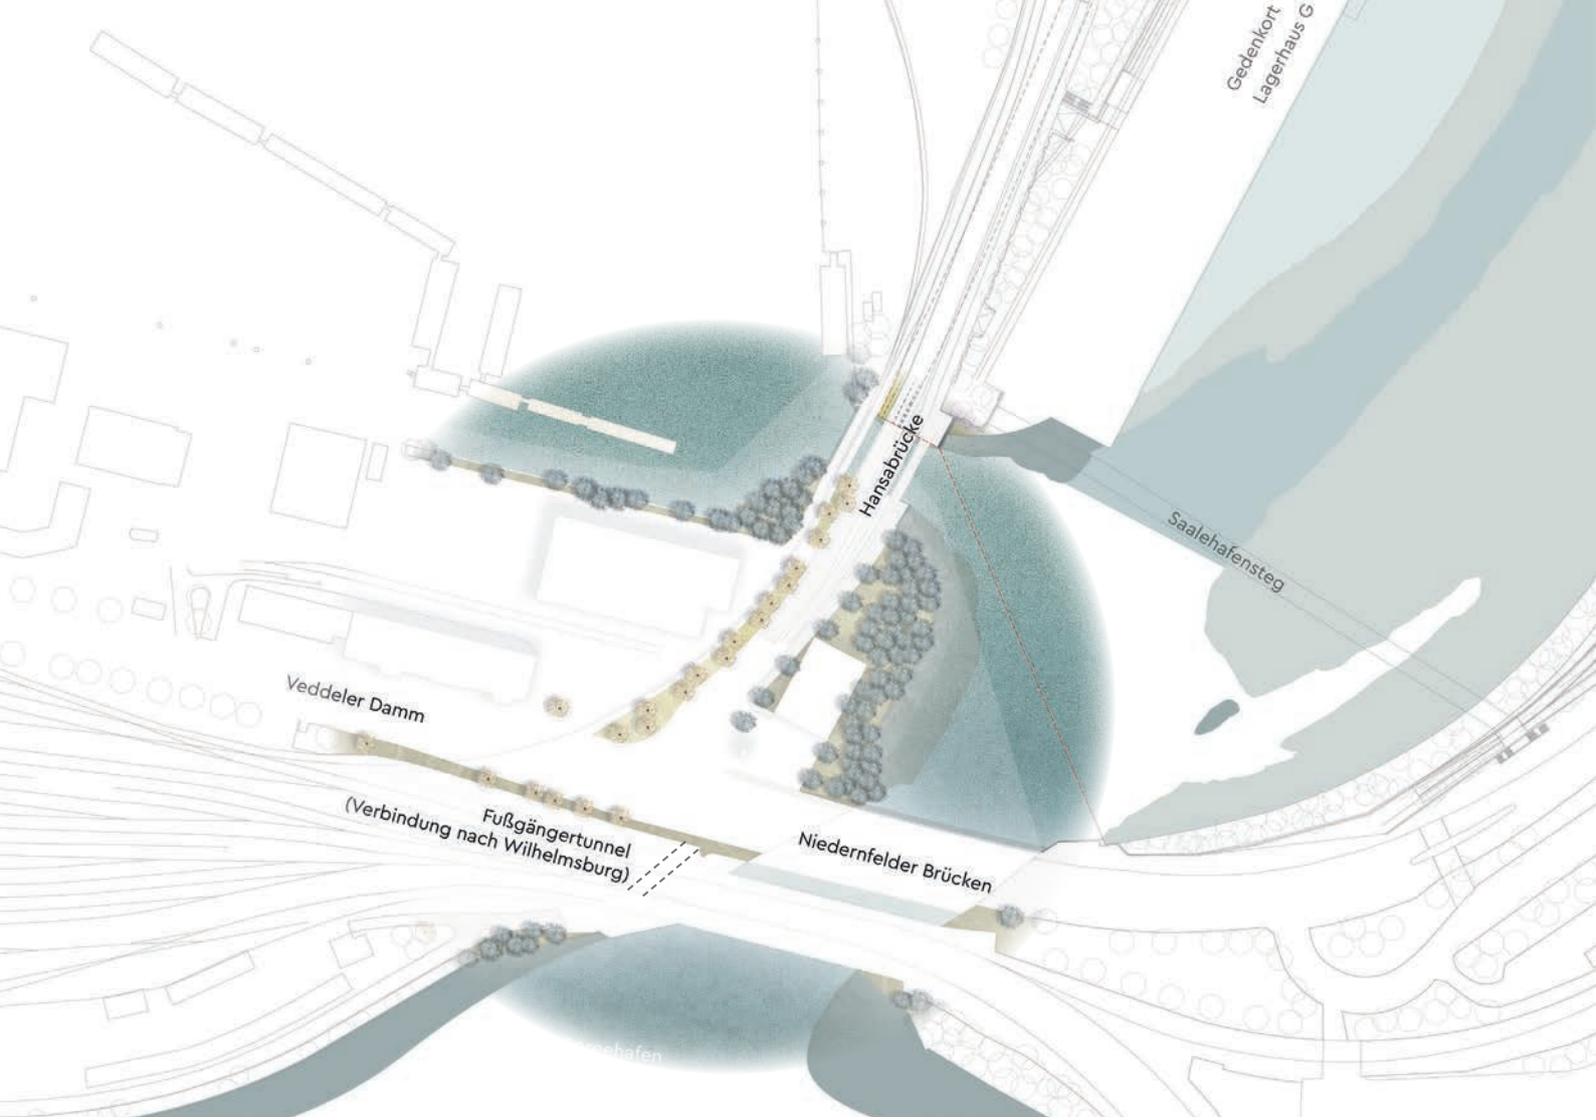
Lageplan Veddeler Damm/Dessauer Straße
